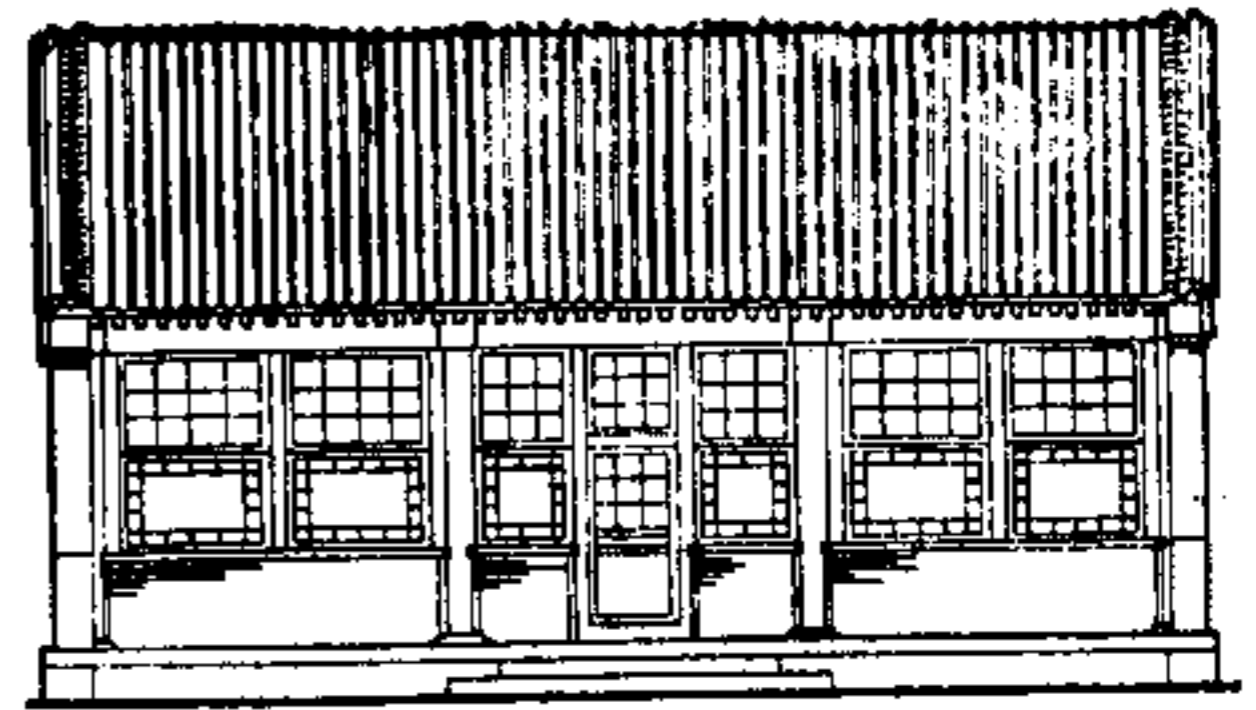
仰瓦灰椽屋面立面示意图
